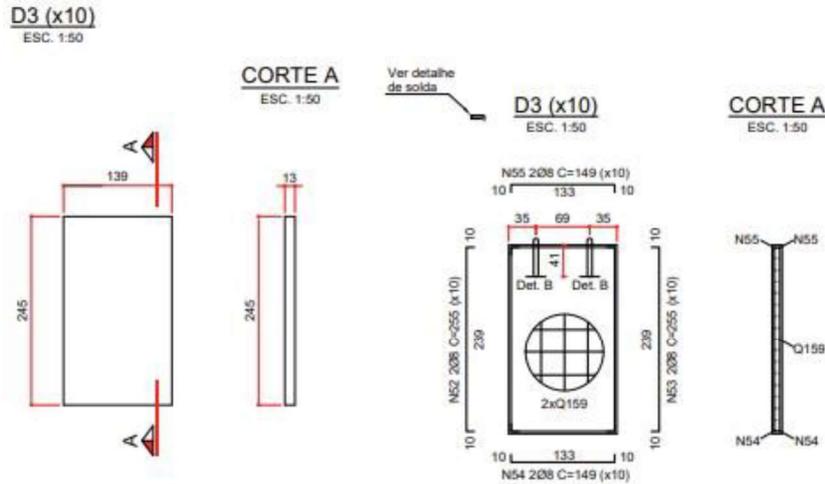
Detalhe da placa D3 do Projeto Estrutural executado
